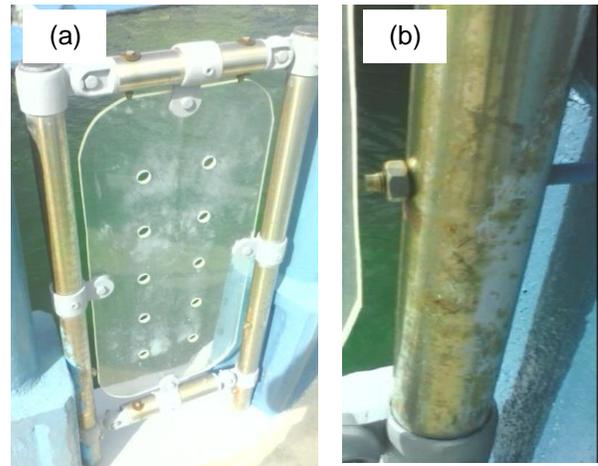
Barandas de acero inoxidable. (a) Vista de la baranda, (b) Detalle del tubo.
